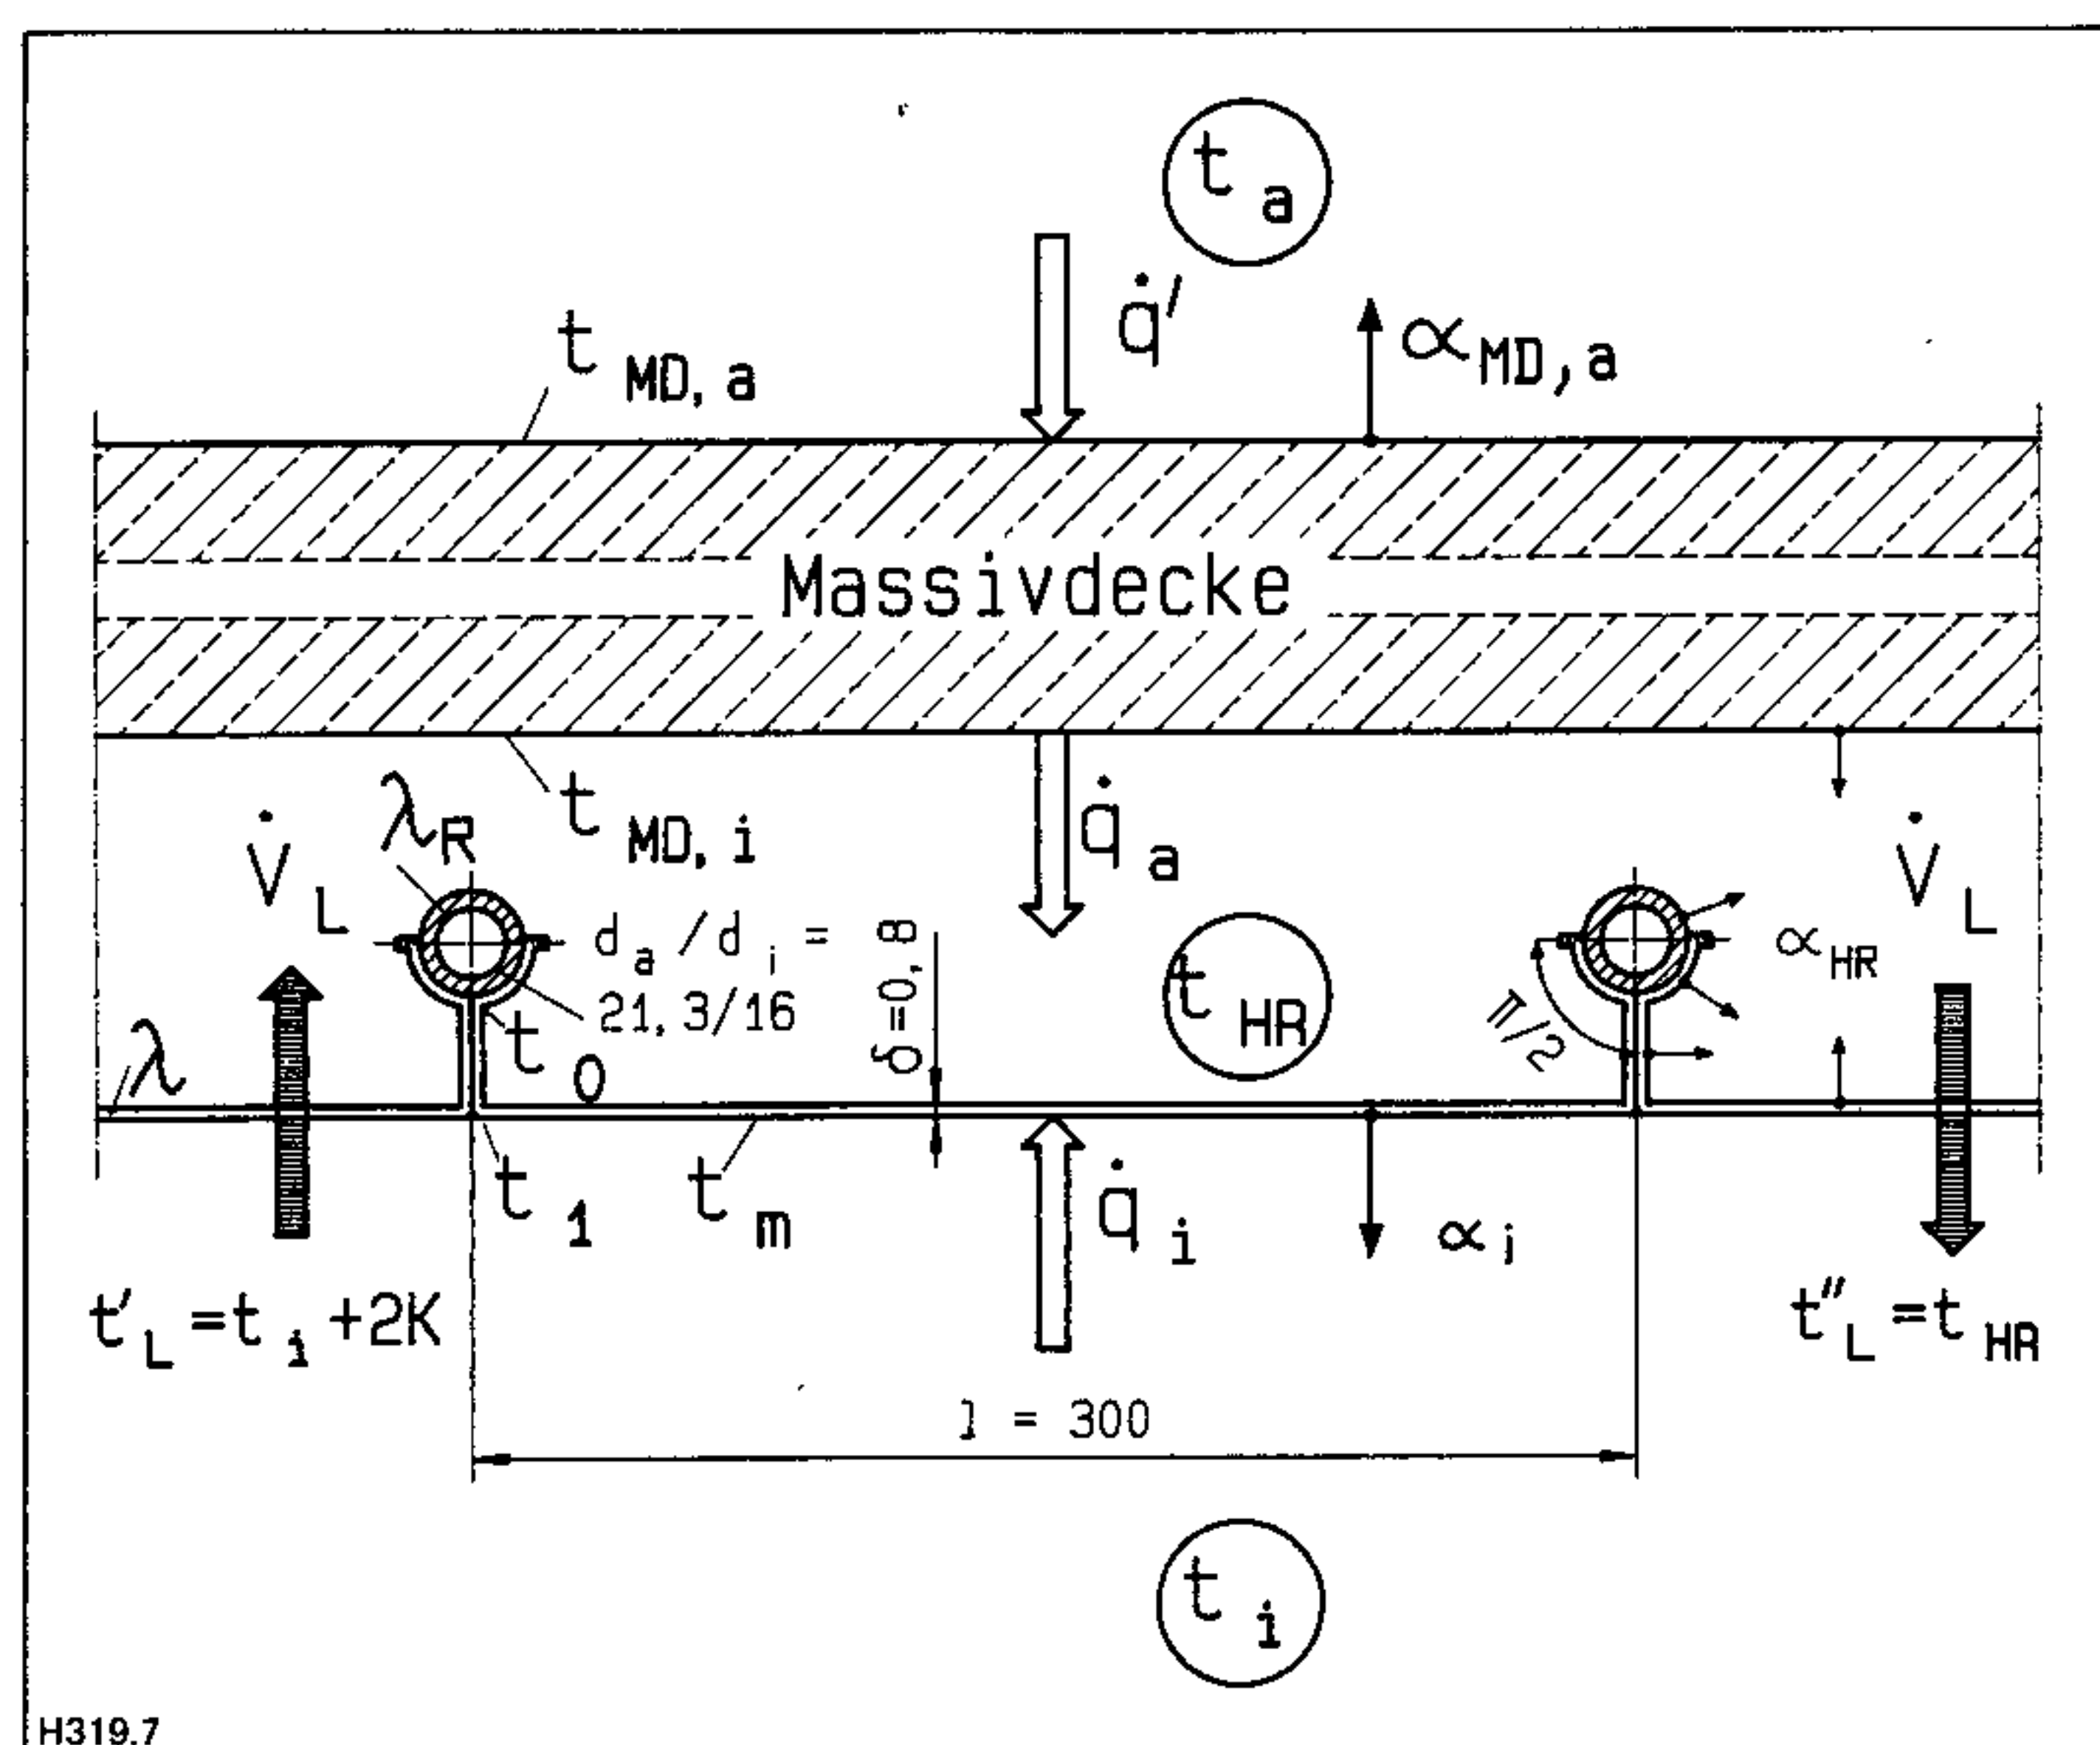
Massivdecke mit untergehängter, offener Lamellenkühldecke ohne Dämmschicht (Abmessungen in mm)
